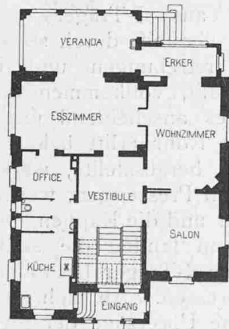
Erdgeschoss des Hauses am Hirzbodenweg 95. Masstab 1:400.
